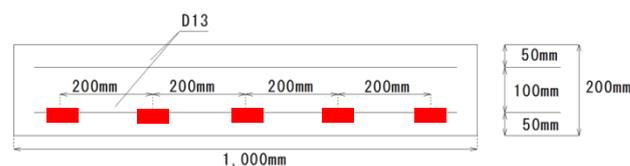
平面図 (単位: mm) ■: ひずみゲージ
